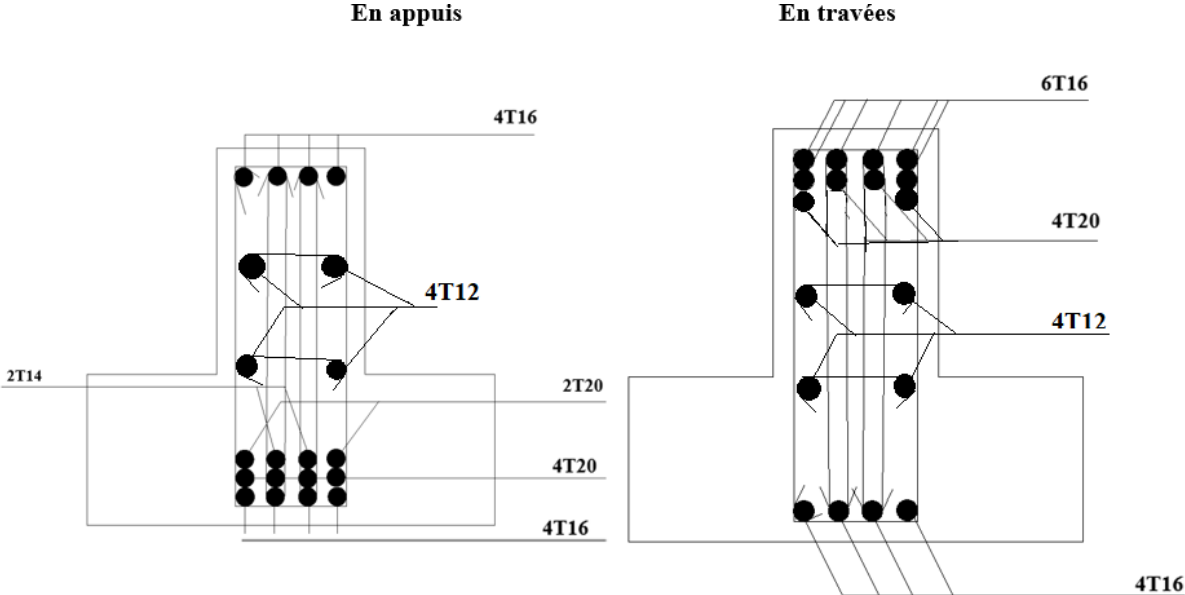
Dessin de Ferrailage de la poutre secondaire.
